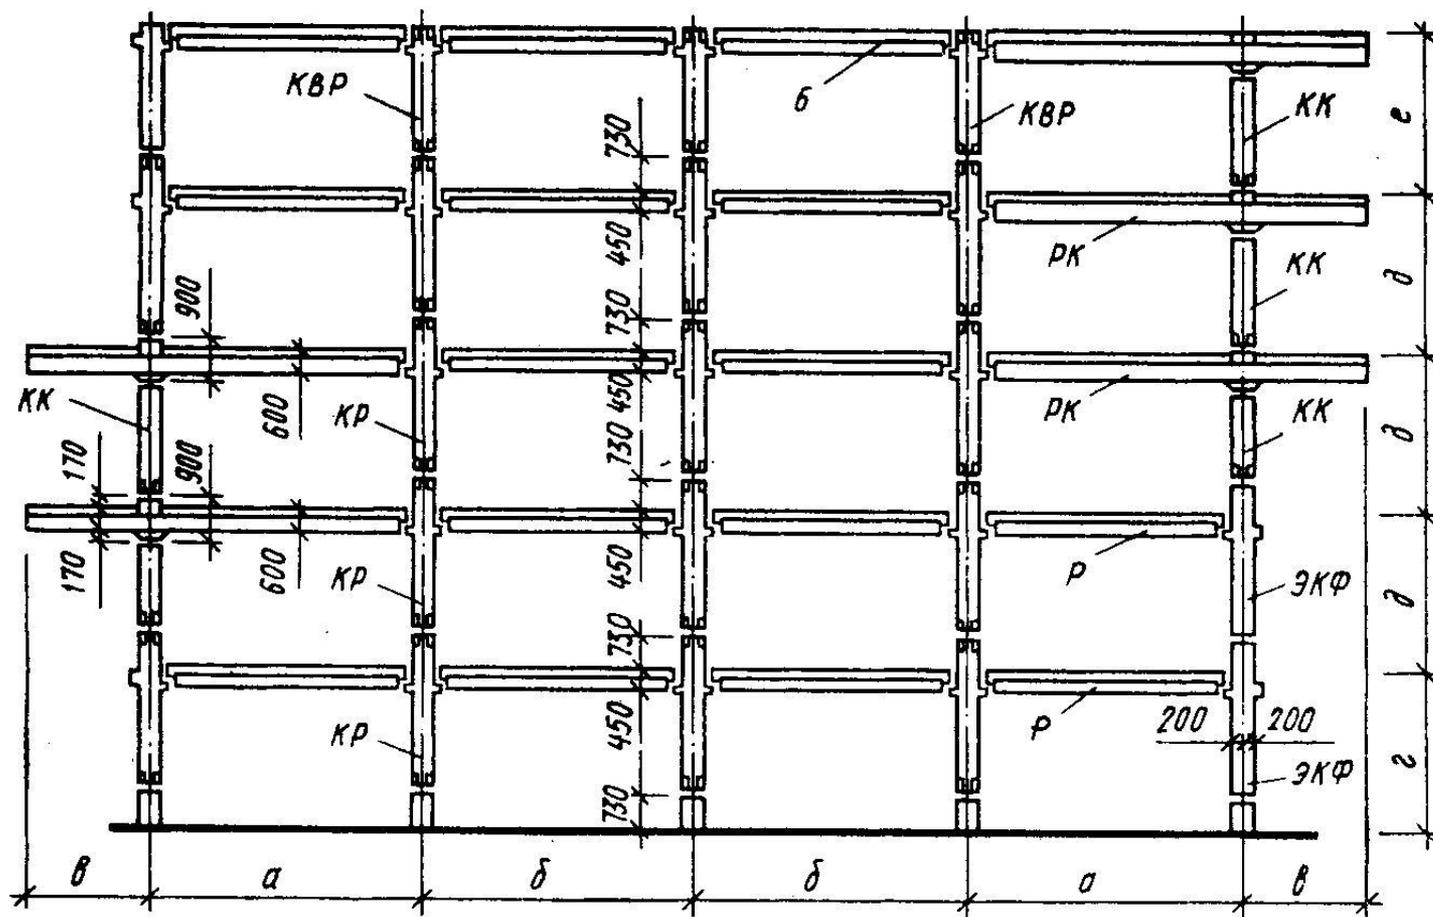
Компановочная схема каркаса с консольными свесами.
